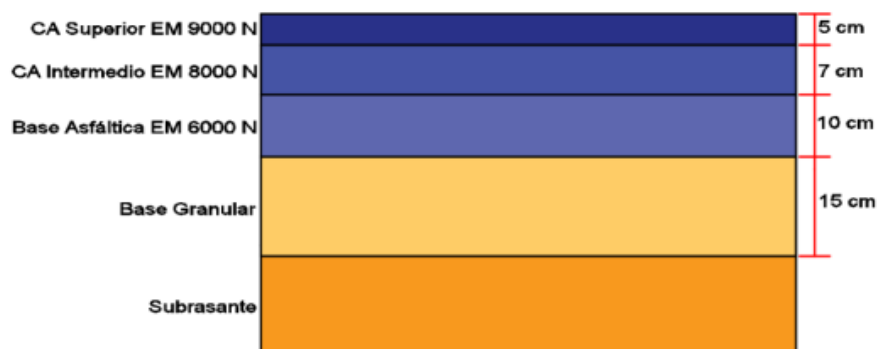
Estructura de Pavimento existente del Tramo 2 [25].
